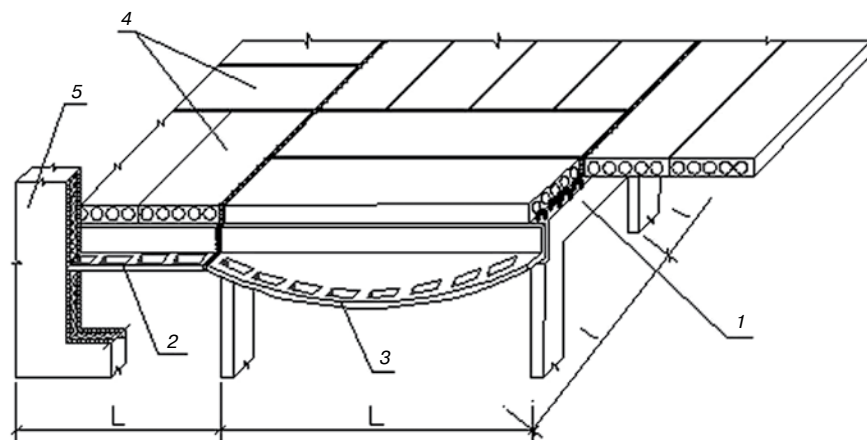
Фрагмент конструктивной схемы здания с каркасом из панельных элементов: 1 – панель-рама; 2 – прямолинейный ригель с терморазъемами; 3 – криволинейный ригель с терморазъемами; 4 – панель перекрытия; 5 – стеновое ограждение
